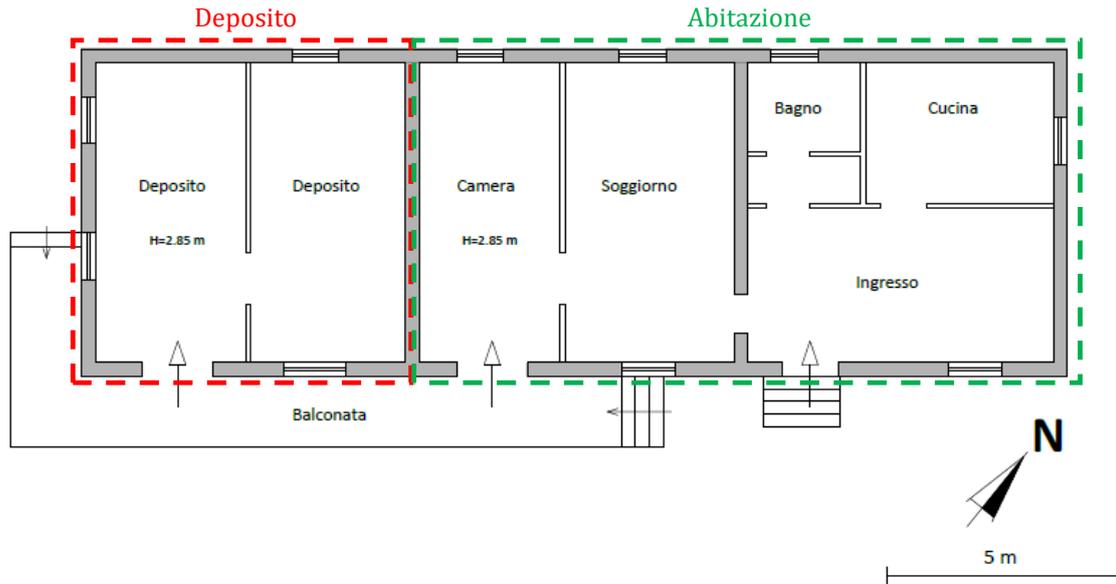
Planimetria dello stato reale dei luoghi – Abitazione e Deposito
